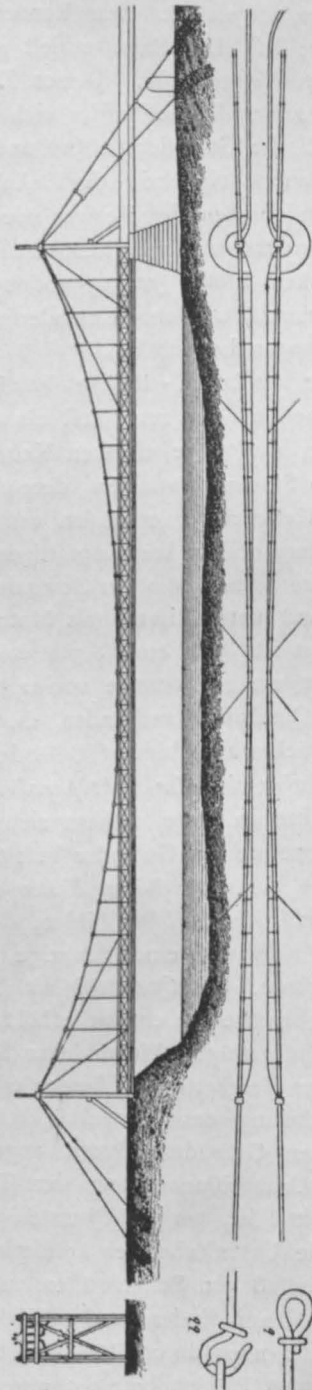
Fußgängerbrücke über den Tweed bei Dryburg-Abbey (1817—1818). Nach NAVIER.
